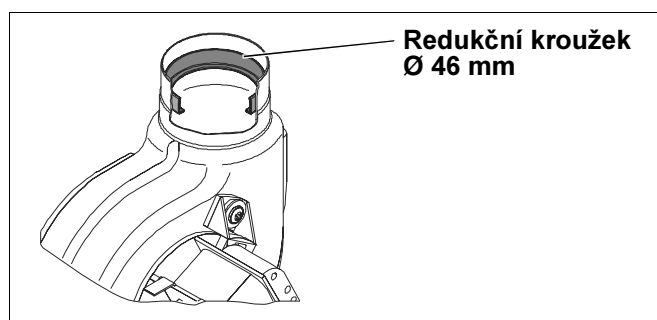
Montáž systému odvodu spalin (rozměr v mm)
